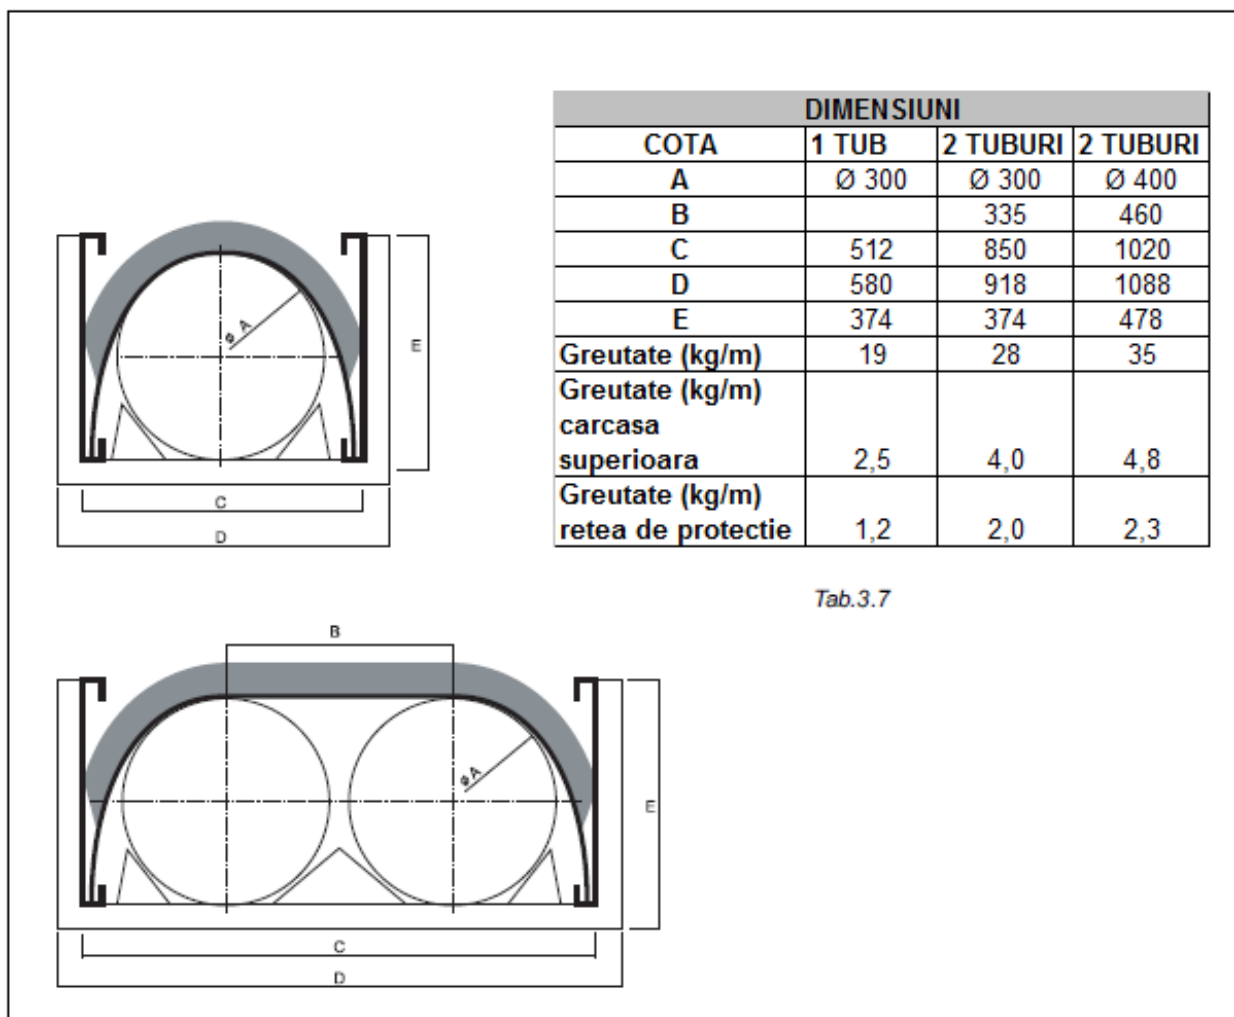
Dimensiuni de ambalare a tubulaturii radiante
